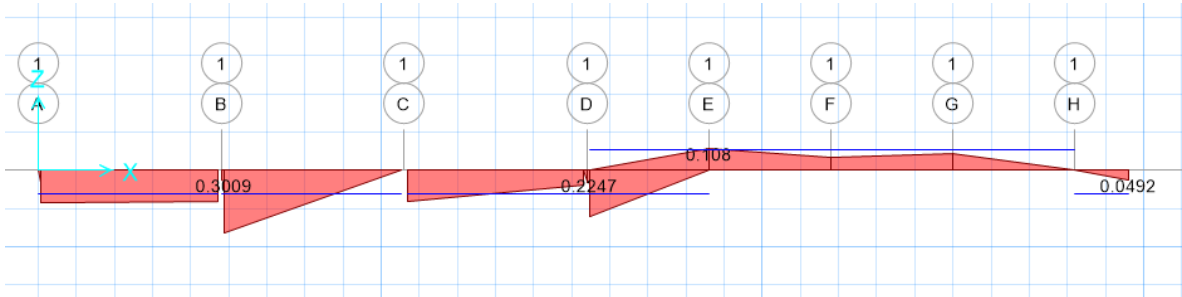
Área de refuerzo en dirección x por franja (losa de sistema de alimentación)
